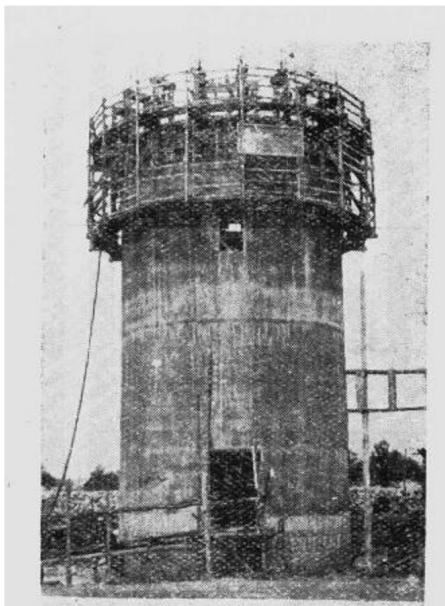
1955 年修建吉林某厂 400 吨钢筋混凝土水塔时
